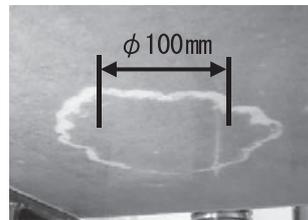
に押し抜き試験を行ったときの施工面の状況を示した。φ 100 mmのコアの削孔残りを写真の反対側から押し抜いており、コンクリートにはく離が発生すると補修材が押されてはく離部の周囲が透明から白色に変わり強調された。写真—4は、躯体にひび割れが生じた時の目視状況である。ひび割れ部のFRP層が白く強調されていることがわかる。
